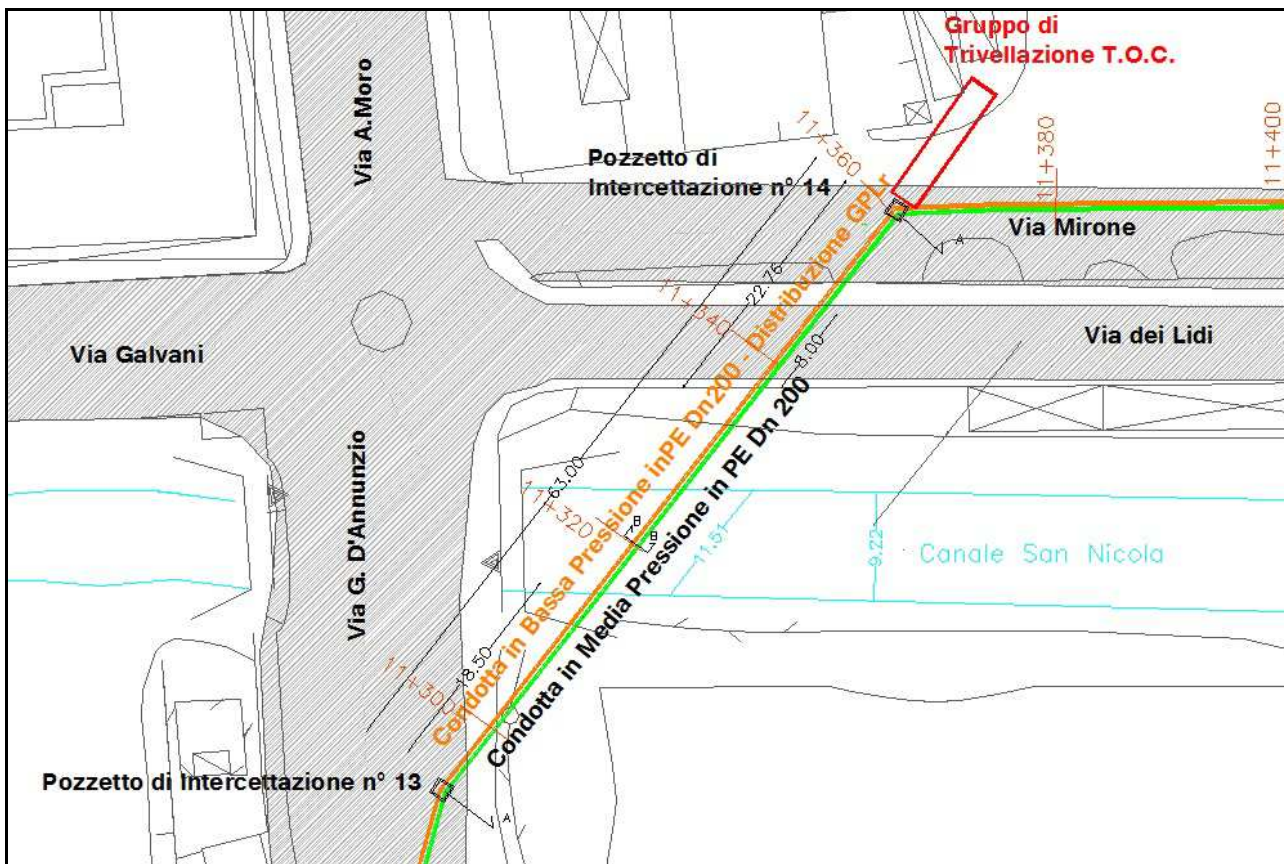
Stralcio planimetrico dell'attraversamento previsto (Elab. I.7).
